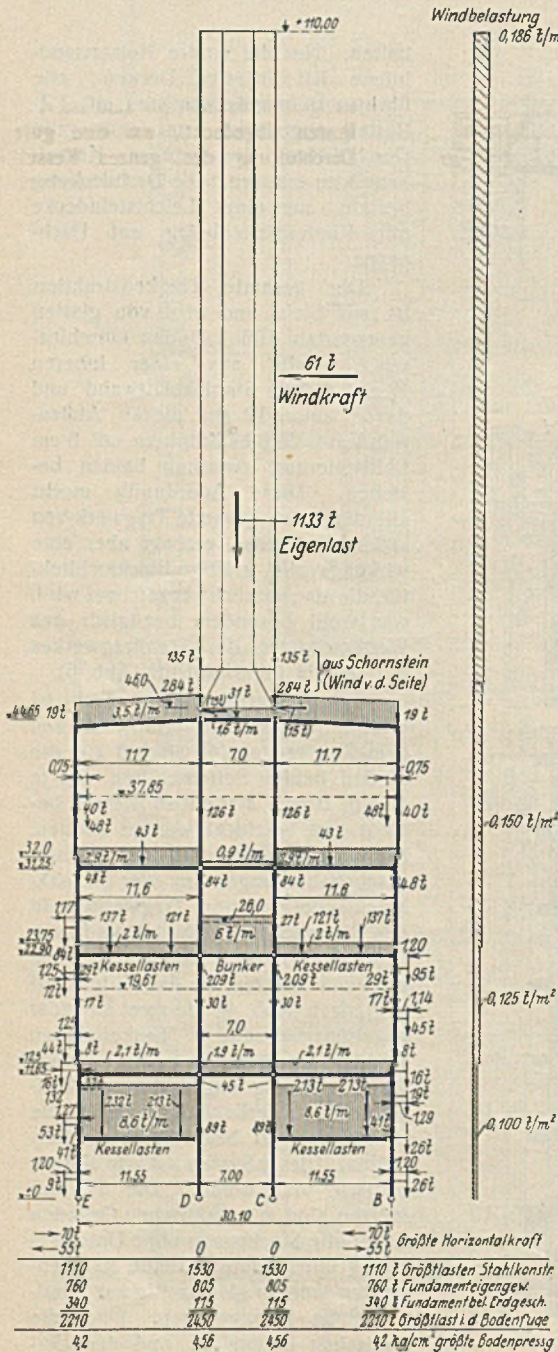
Statisches System und Belastungsschema des Kesselhauses.
